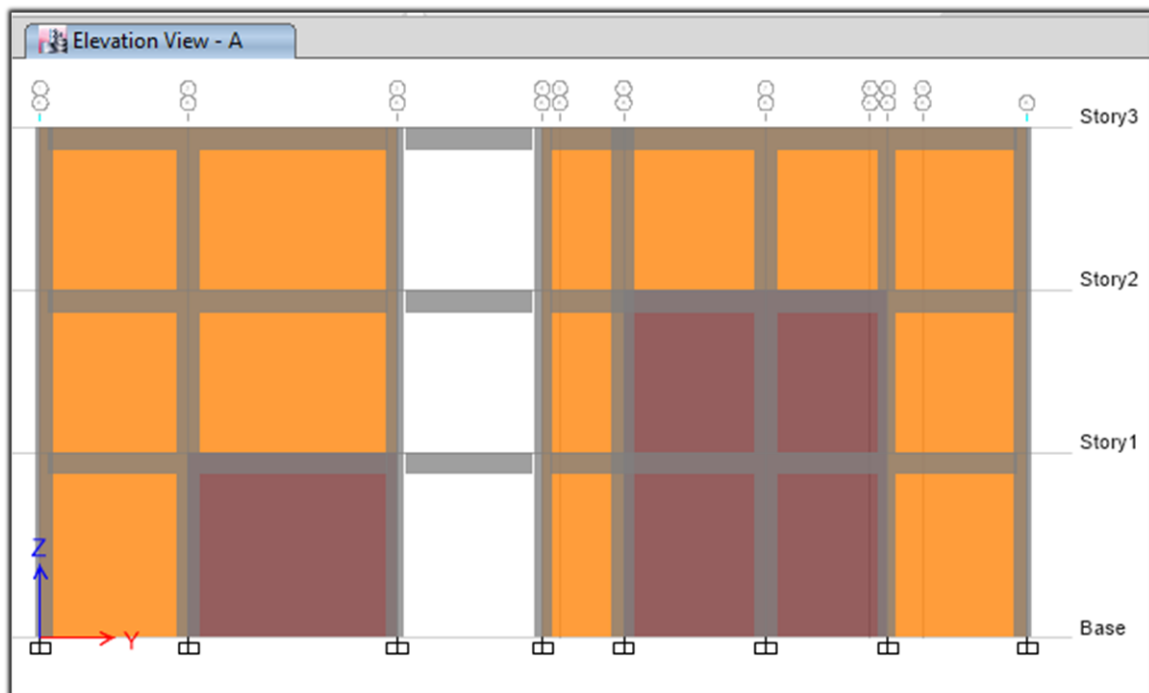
Ubicación y colocación del refuerzo en el eje A en Y-Y
